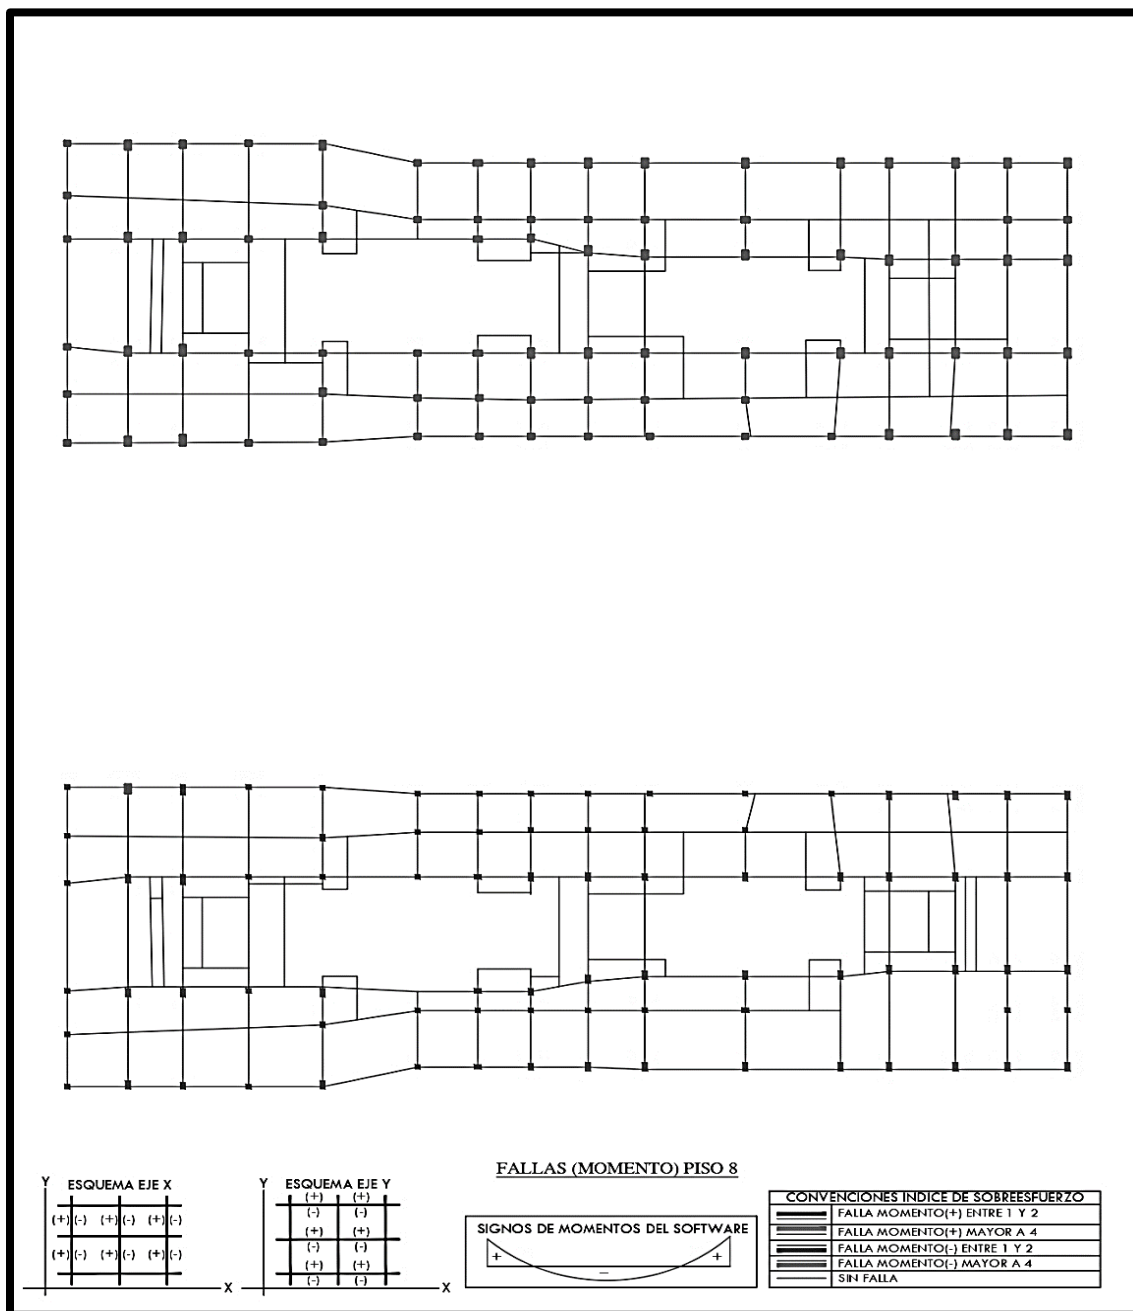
Plano de secuencia de fallas (Momento) nivel 8. Fuente: Los autores
